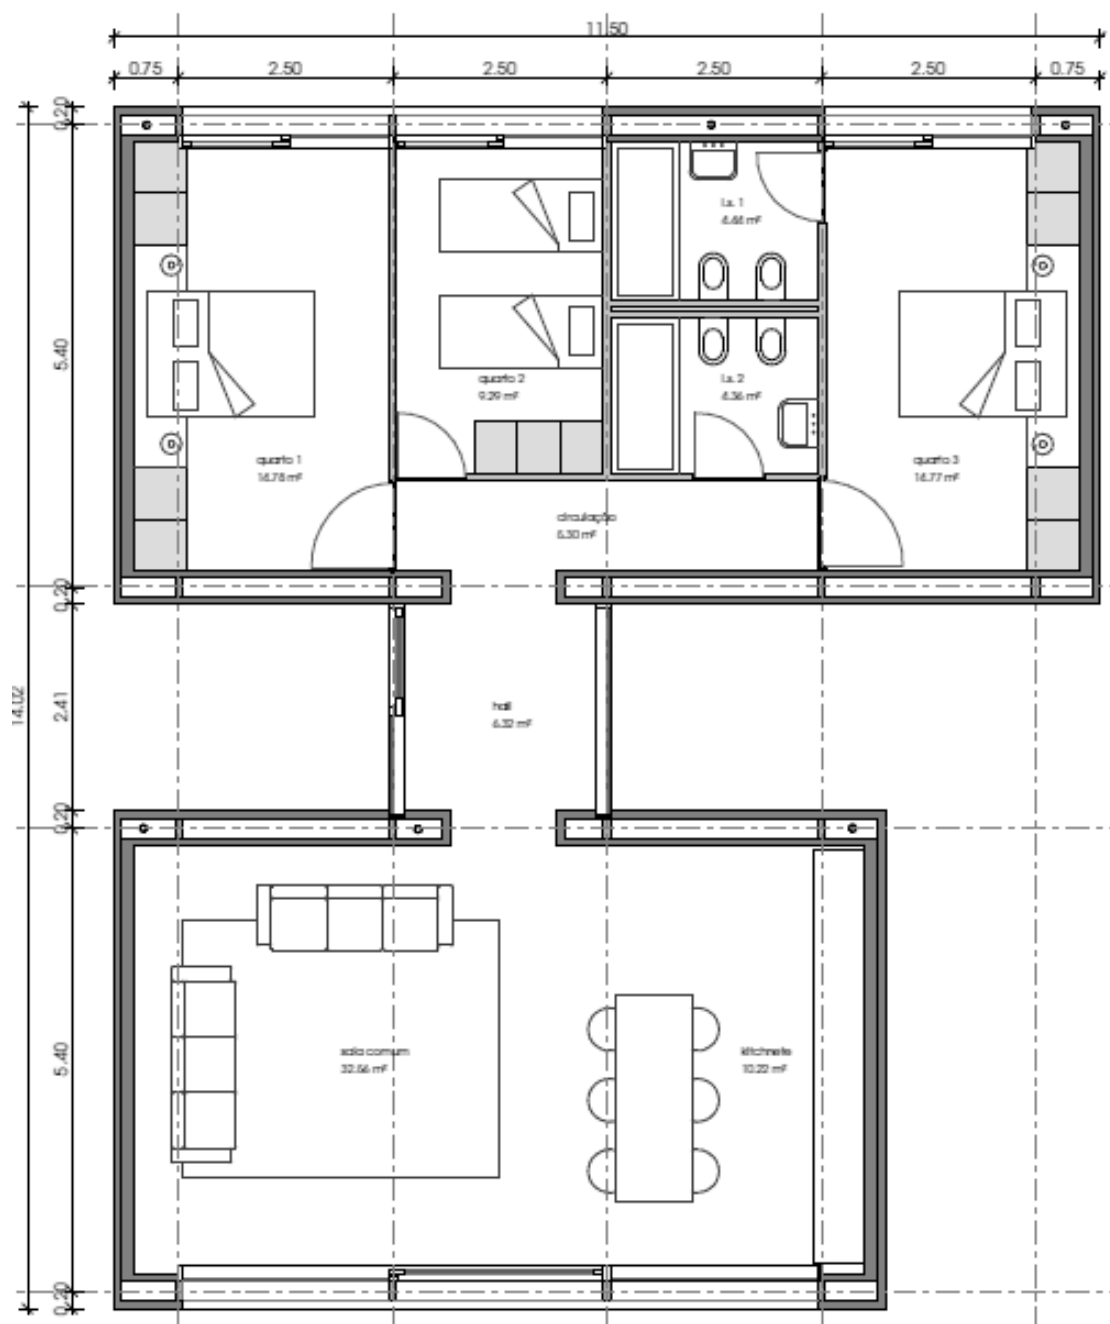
Planta modelo "M.1+" (ModularSystem, 2003)
